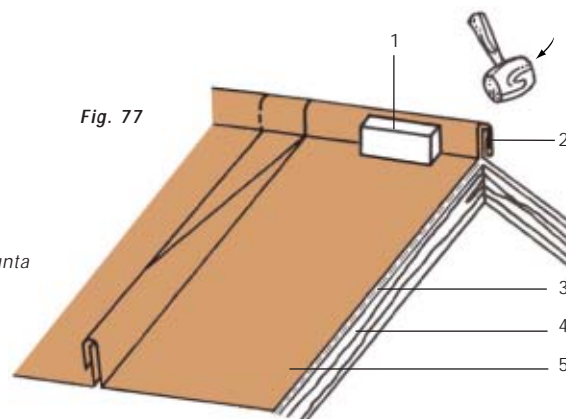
Detalhes construtivos da junta elevada da cumeeira - Continuação
